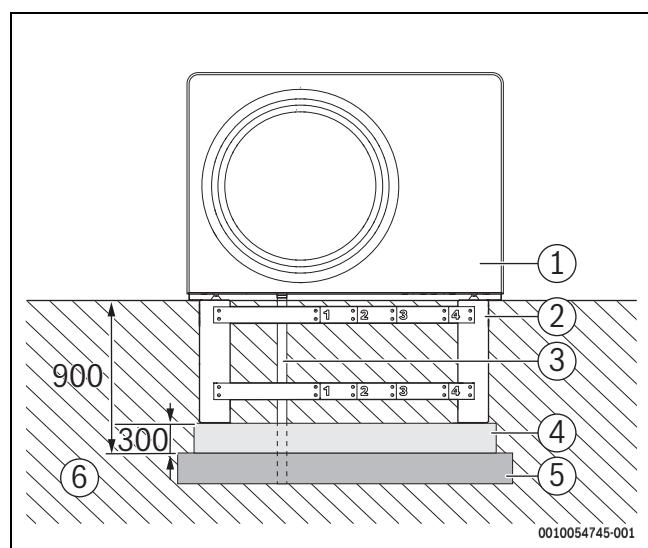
Exemple de mise en place : fondation préfabriquée dans le sol
